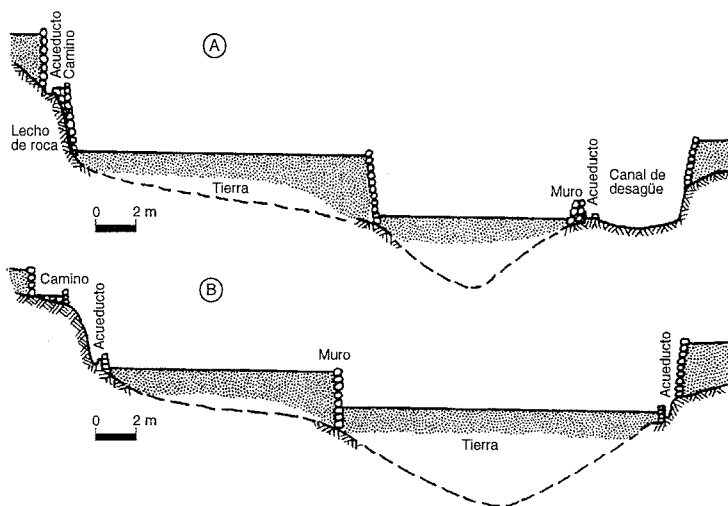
Sección de un sistema de terrazas elevadas construido en un valle cerca de Amminadav. Las terrazas cubren el ancho total del valle. El manantial atraviesa las terrazas de manera subterránea. Para facilitar el drenaje, el cauce ha sido reemplazado por un canal de desagüe en la margen este, excavado en la pendiente y con una pared que protege las terrazas adyacentes (A), o que desagua en las acequias laterales (B). (Mapa realizado por Z. Ron).
